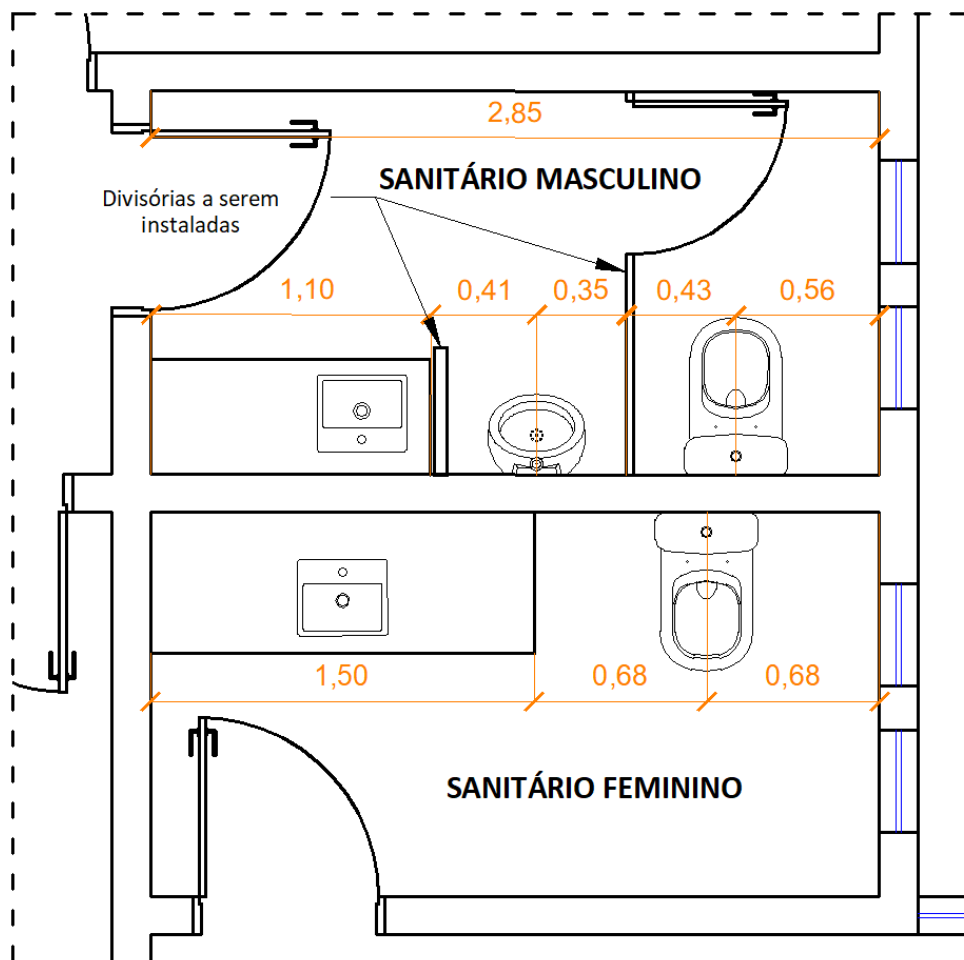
Planta baixa e posicionamento dos elementos dos sanitários do pavimento superior
